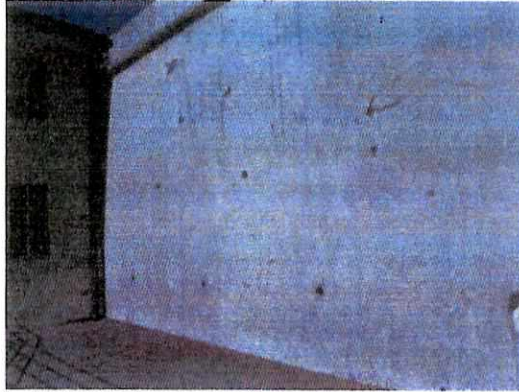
Humedad en muro colindante con predio utilizado como parqueadero posterior al Teatro Capitol
